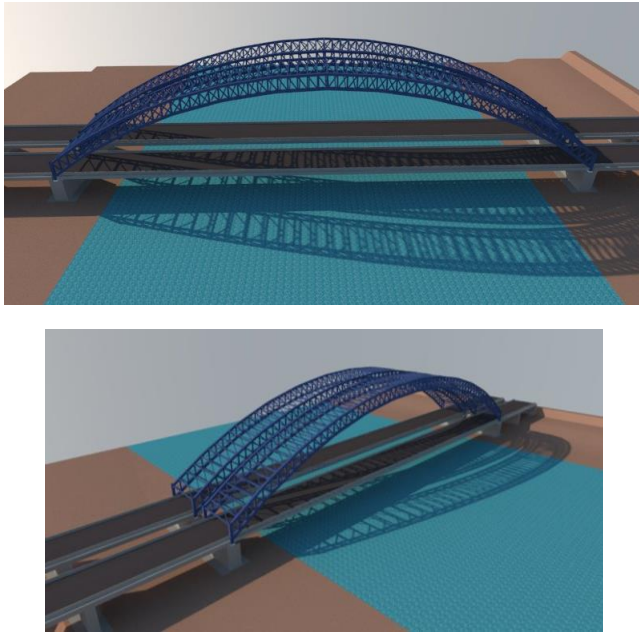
17 Konstruksi Plat Lantai Jembatan
